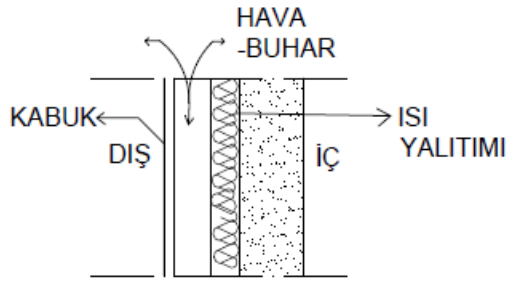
4 : Normal betondan dolu gövdeli cephe panelleri
